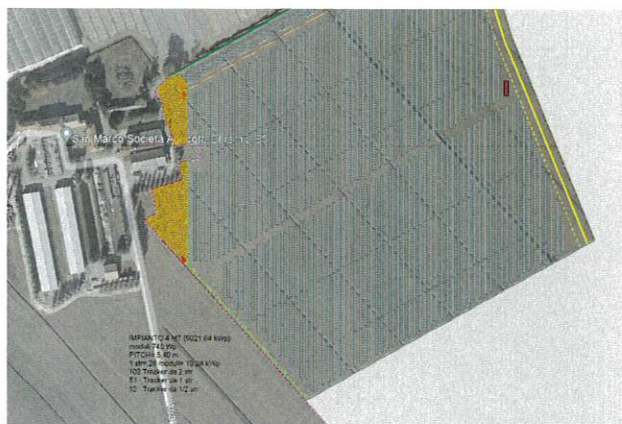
Sottocampo 2-4 (cfr elaborato TAV.10.2 - Planimetria di dettaglio - sottocampo 2-4 REV.01_signed)
